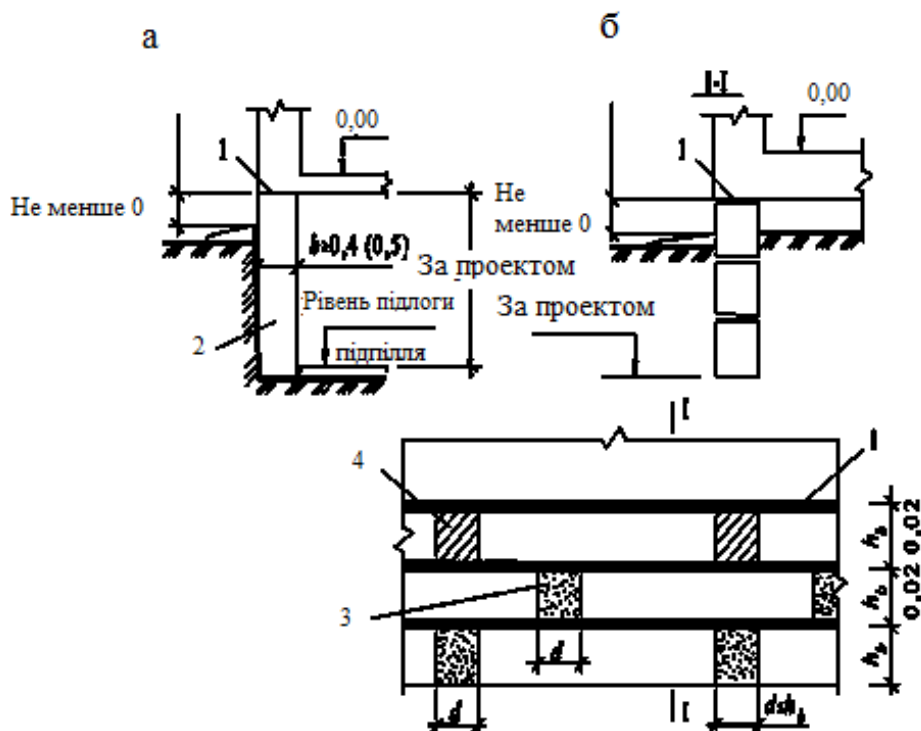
Фундаменти без розширення до підшови для одно- і двоповерхових будівель: а – бутові і бутобетоні; б – зі збірних стінових блоків; 1 – два шари толю або гідроізоли на бітумній мастиці; 2 – обмазування гарячим бітумом за два рази; 3 – утрамбований ґрунт; 4 – цегляна кладка
